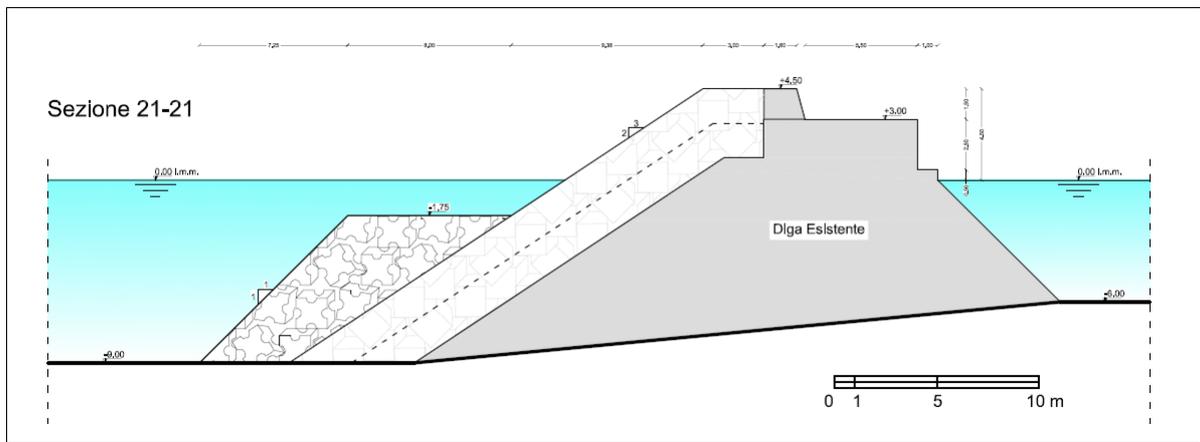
Sezione 21-21: consolidamento molo di sopraflutto
